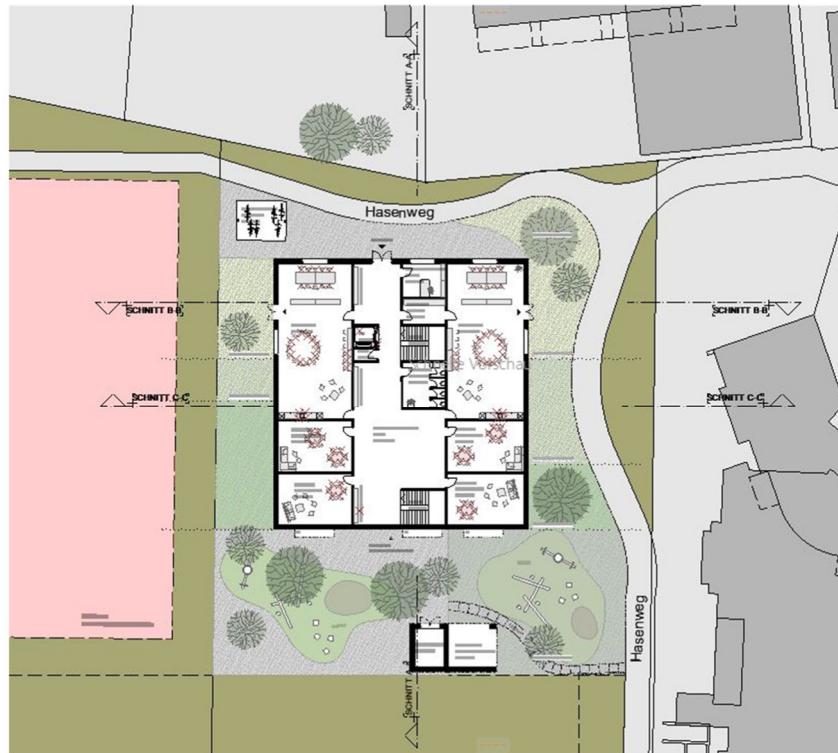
Disposition 02 | Grundriss Erdgeschoss
